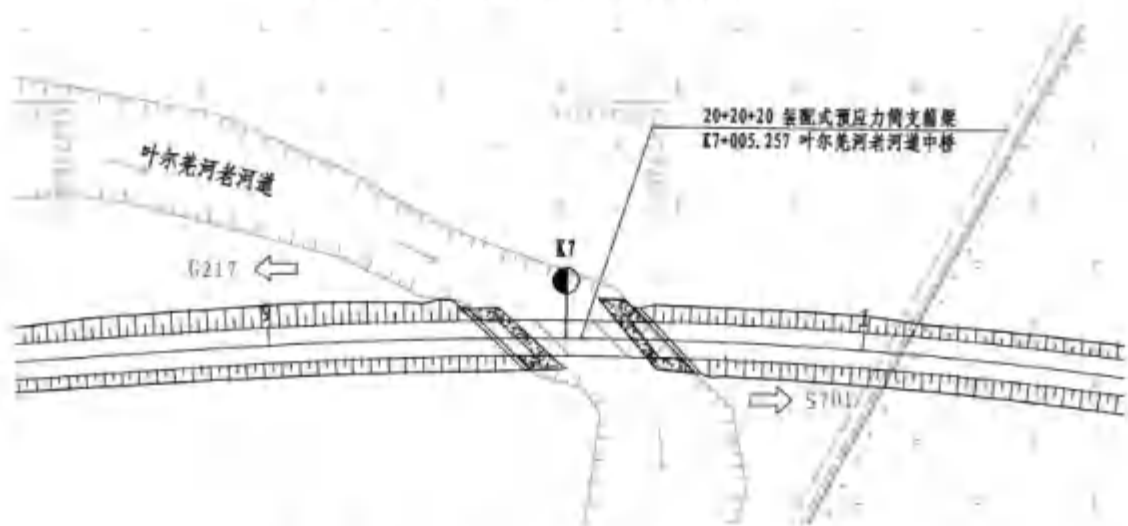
叶尔羌河老河道中桥桥位平面图
